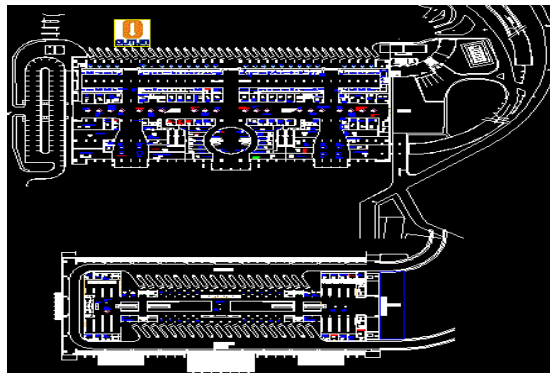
Planta arquitectónica. Terminal de Guayaquil.
